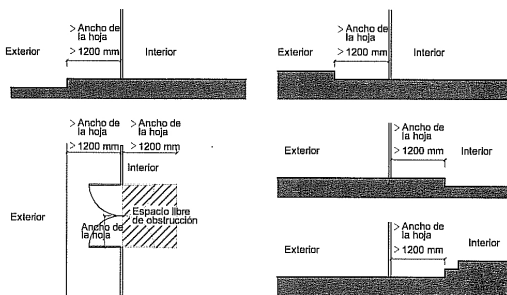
Distancia entre la puerta de acceso y el escalón más próximo
